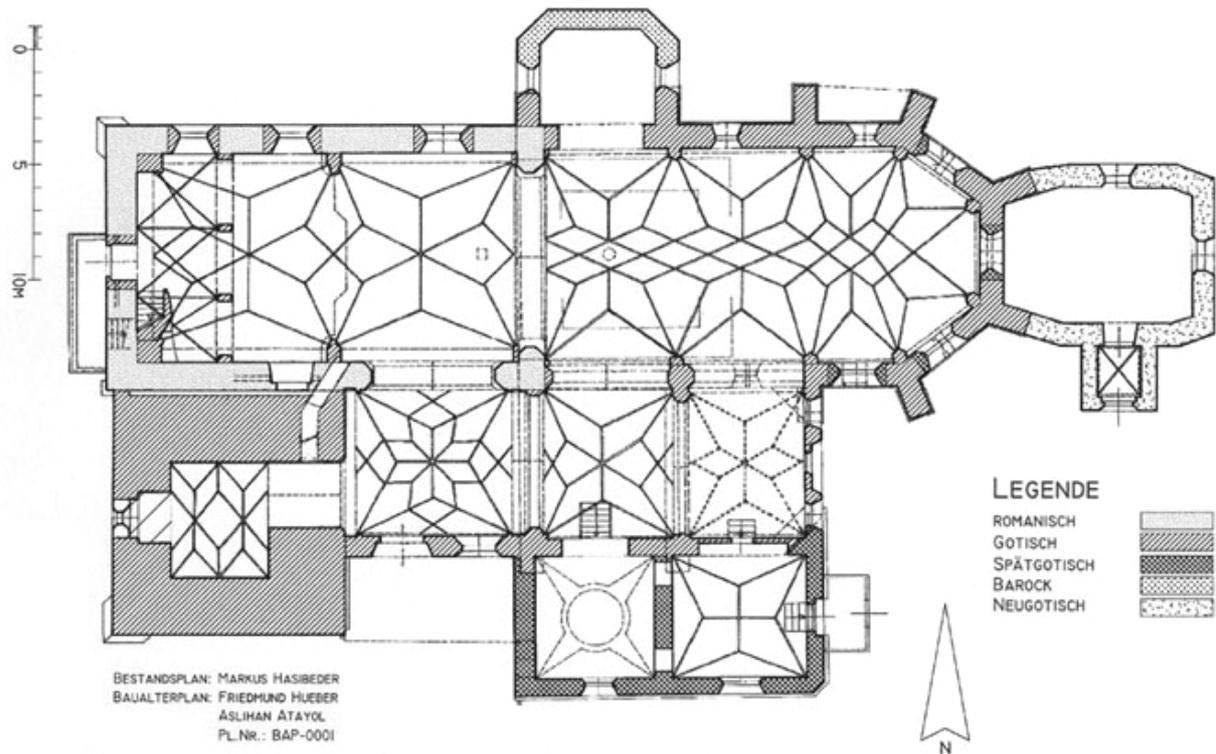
Baualterplan der Pfarrkirche von Bad Aussee/Stmk.
